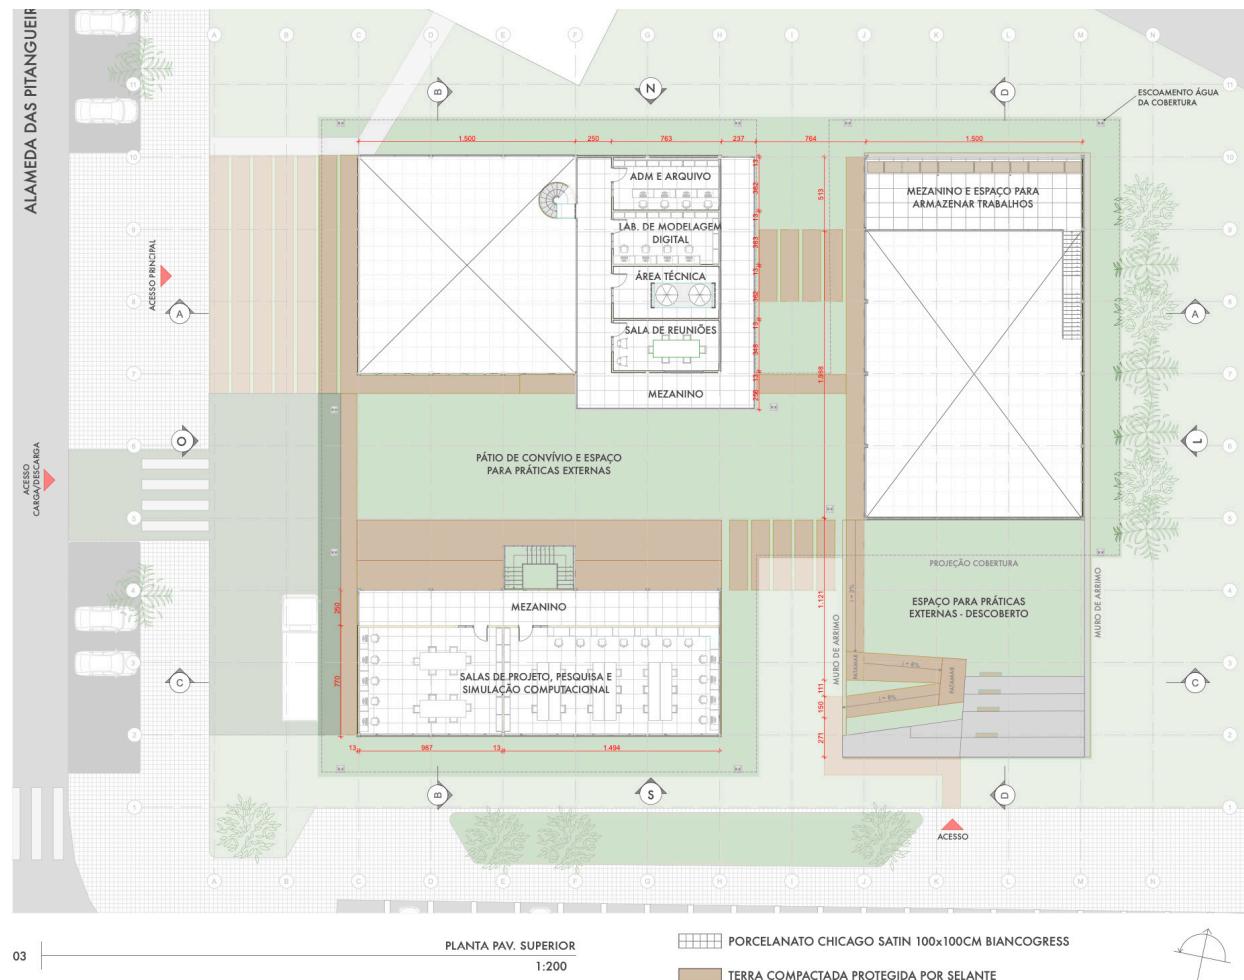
Planta do pavimento superior. Fonte: Autora.
